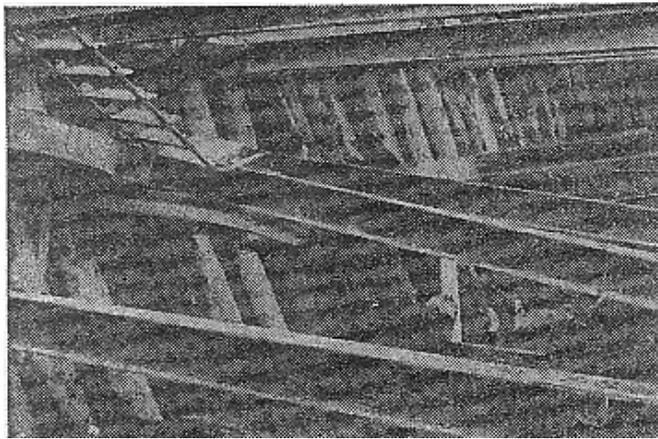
支保工破壊及び T. A. W 杭の変状
